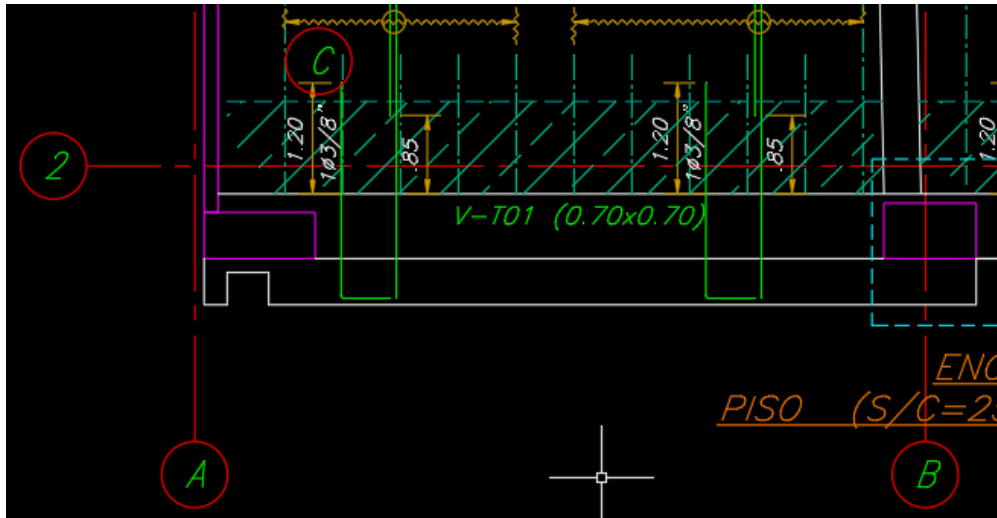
Ubicación en planta de sección de viga V-T01 (0.70x0.70)
